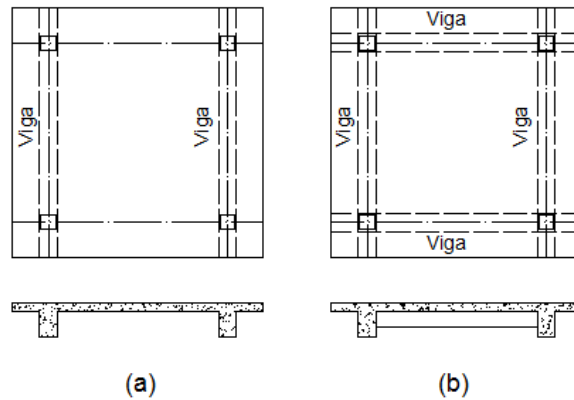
1 Tipos de losas: (a) Losas unidireccionales; (b) losas bidireccionales.
